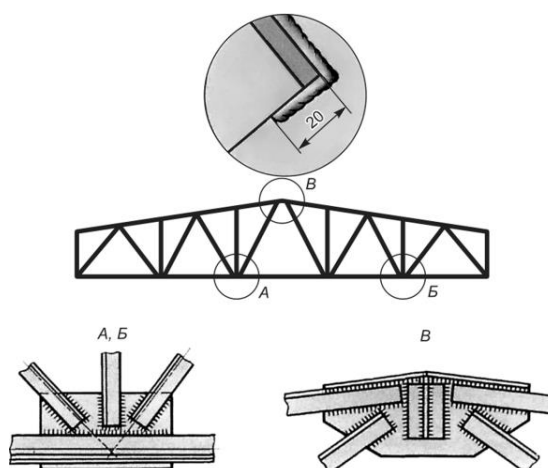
Сварка фермы и ее узлов А, Б, В
